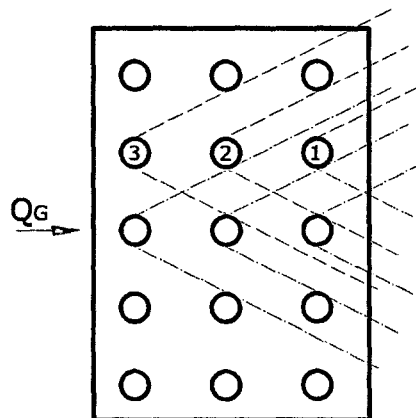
Planta de grupo de pilotes sometido a fuerza lateral.
